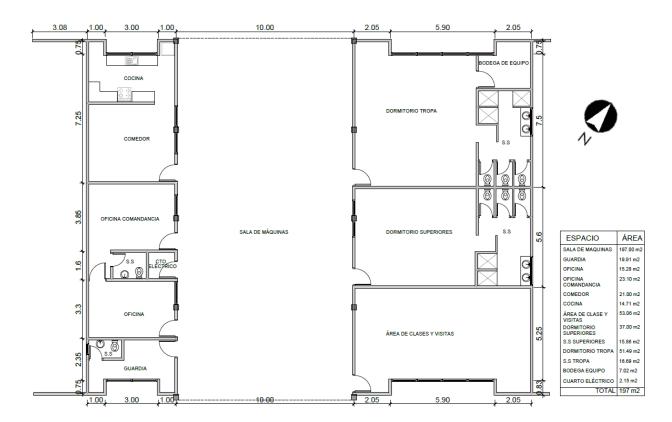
Planta arquitectónica Estación de Bomberos de Villanueva
